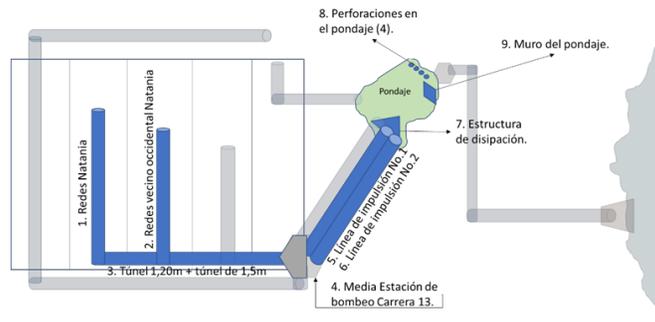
Esquema del componente alcantarillado pluvial SAI ETAPA 1.
